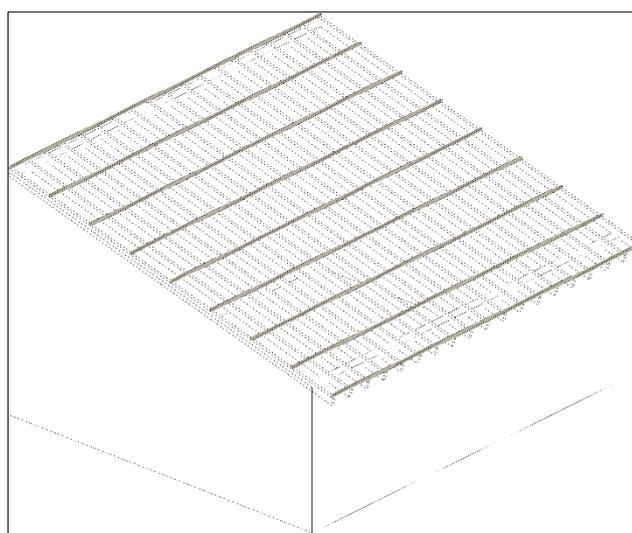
Planta demonstrando os elementos estruturais e seus vãos.
